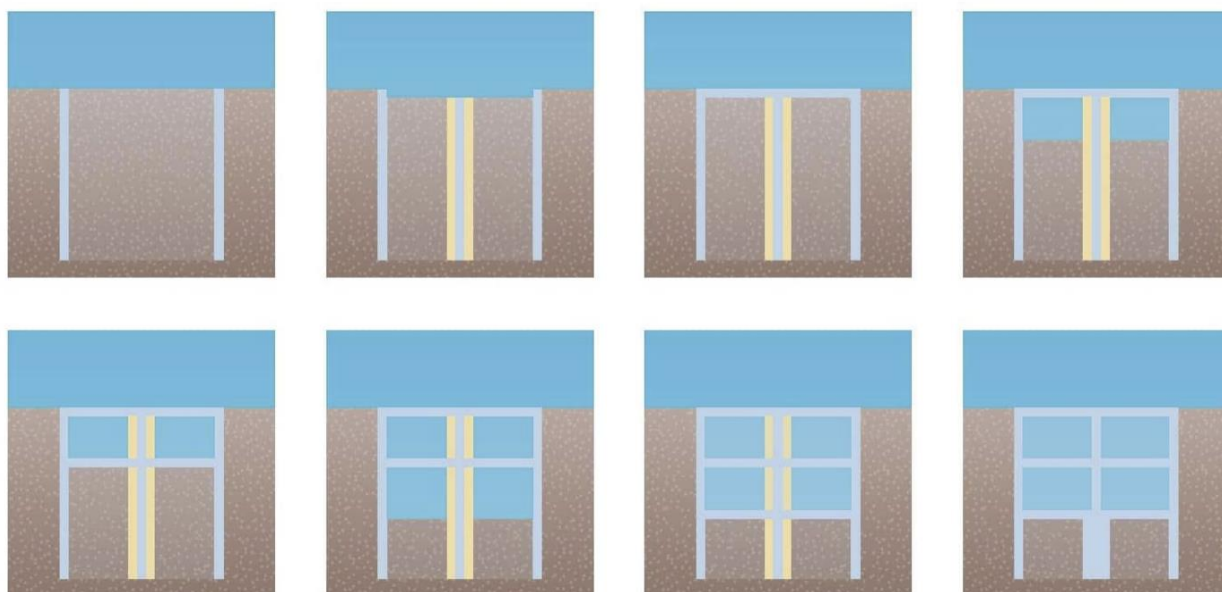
costruzione corpo centrale stazione con tecnica "top-down"
